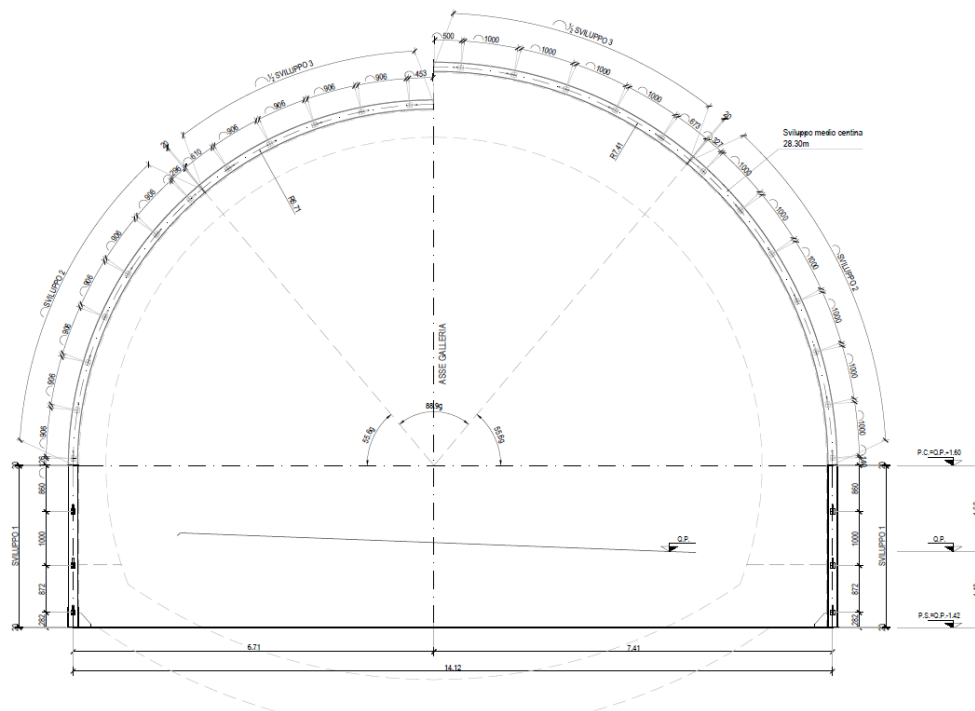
Sezione tipo B0v – Infilaggi metallici
